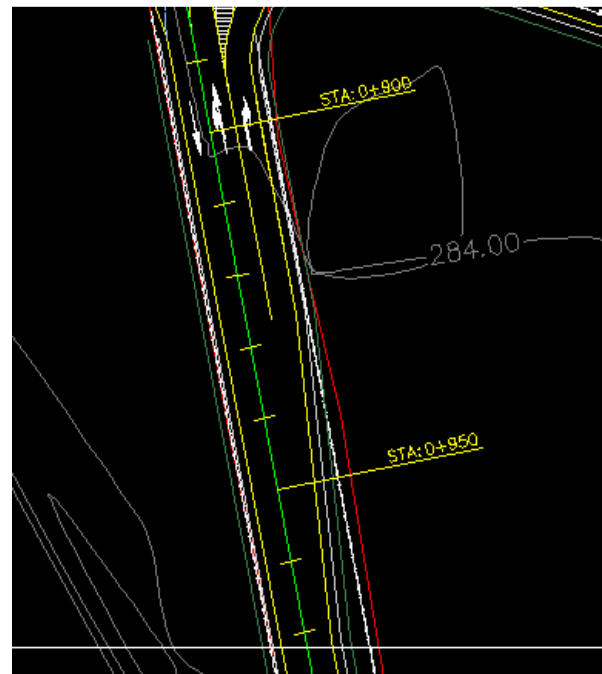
Detalle en planta de un carril para giro. (Fuente: El Autor)
